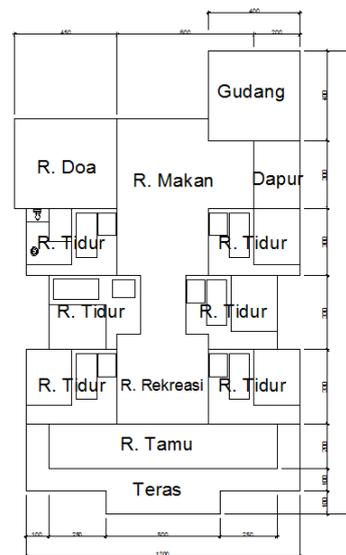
Denah ruang pada bangunan *sao ria* Suku Ende Lio di desa Wololele A
